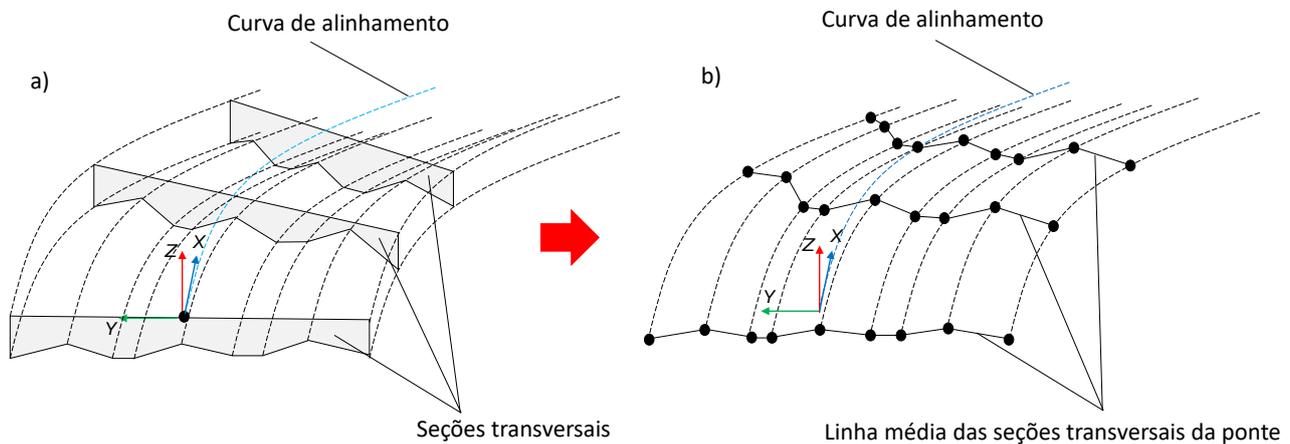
Lajes: a) seções transversais da laje; b) tradução para o respectivo elemento analítico.
